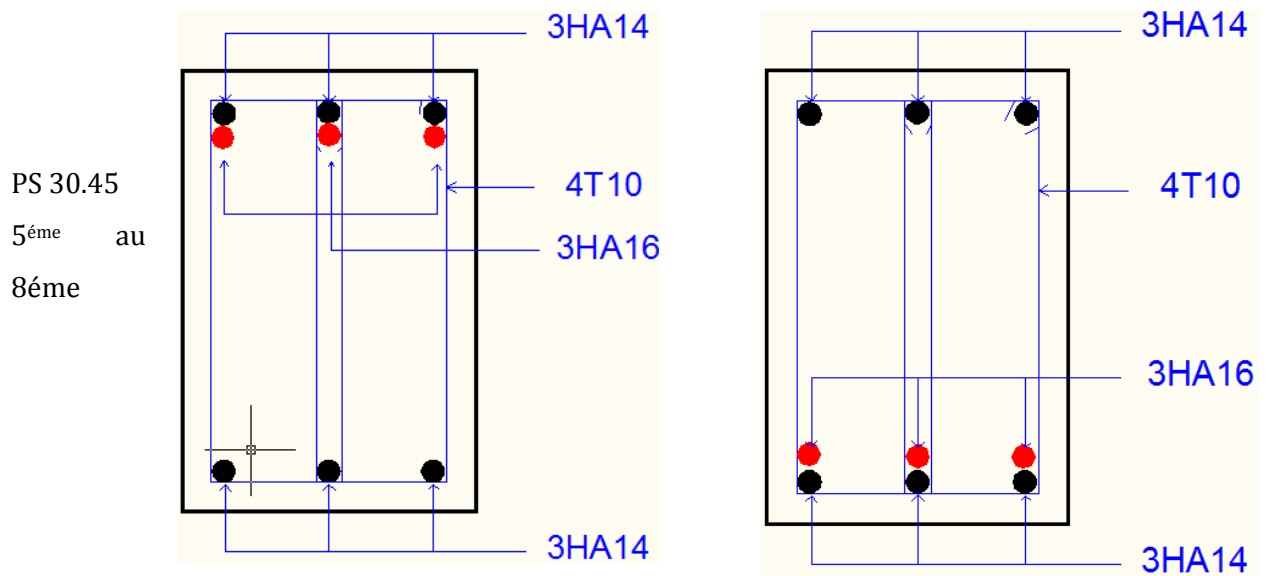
Section de ferrailage des poutres secondaire 5ème au 8ème.
